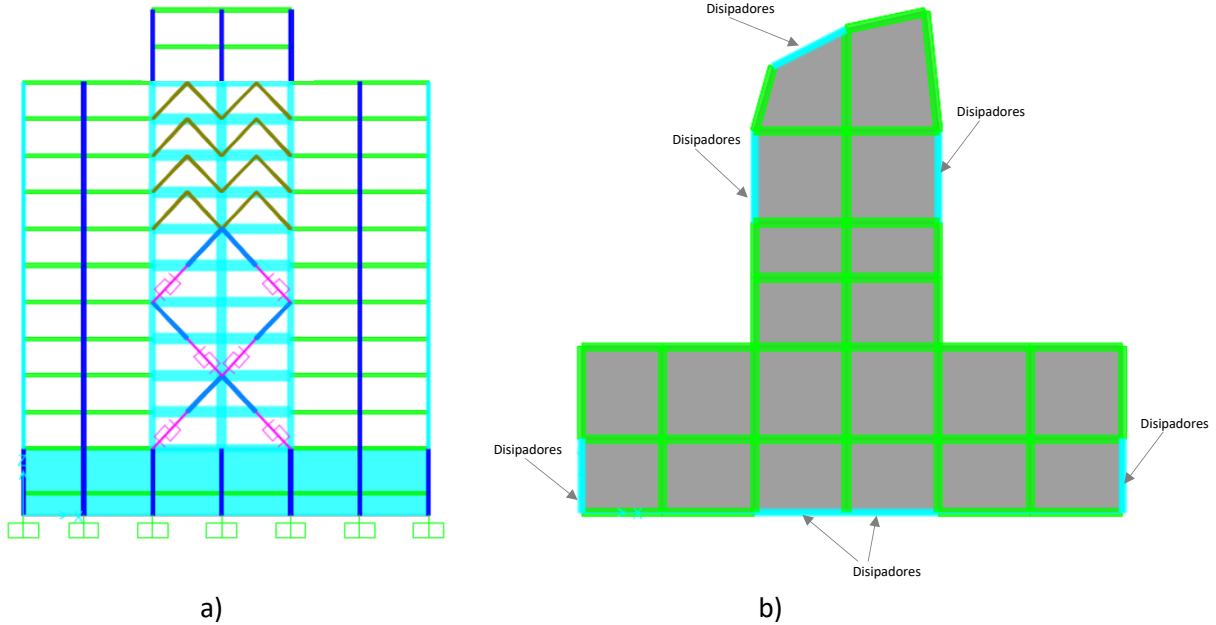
Propuesta de reforzamiento con CRPs y contraventeos convencionales colocados de manera alternada: (a) Elevación Eje A y (b) Vista en planta
